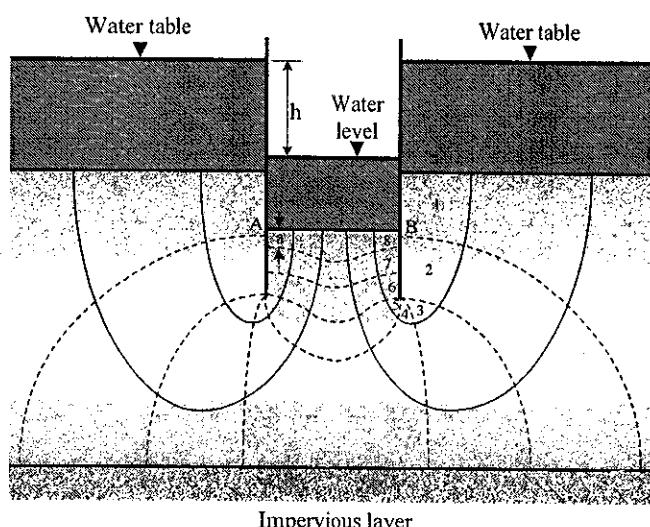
การเกิดห่อกลวง (Piping)
